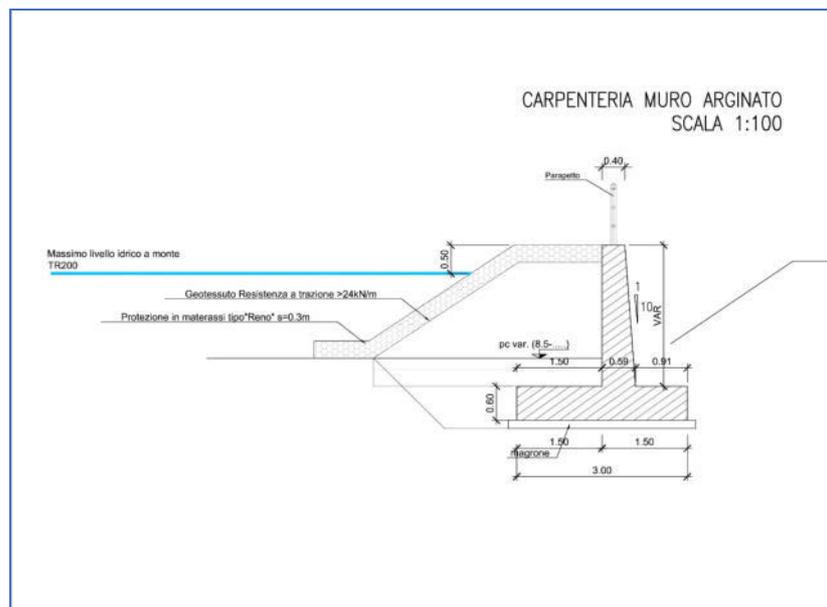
Muro di difesa dagli allagamenti della zona di Fontanarossa (a monte della linea Ferroviaria) – sezione tipo
